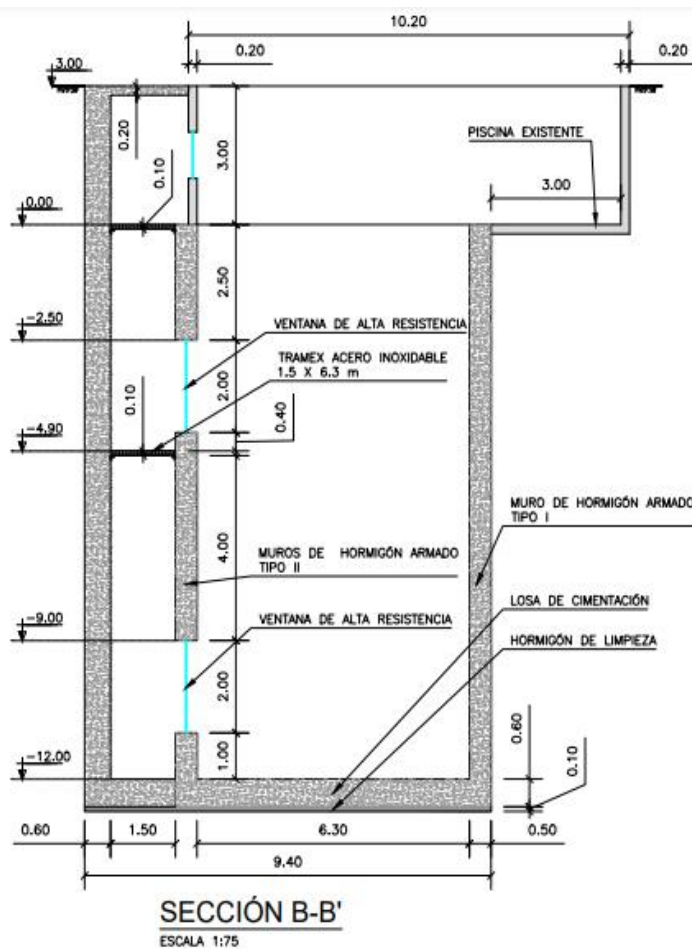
Plano de corte en perfil: vaso y galería subterránea piscina avanzada
